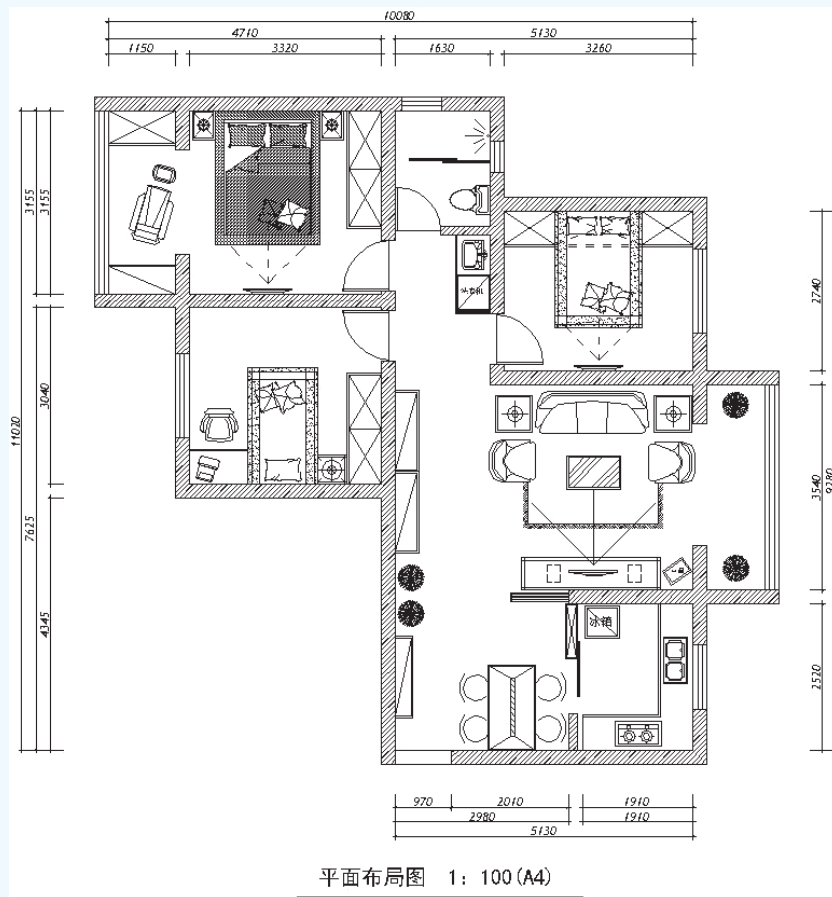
开封帝湖世家建筑装饰 CAD 平面布置图
